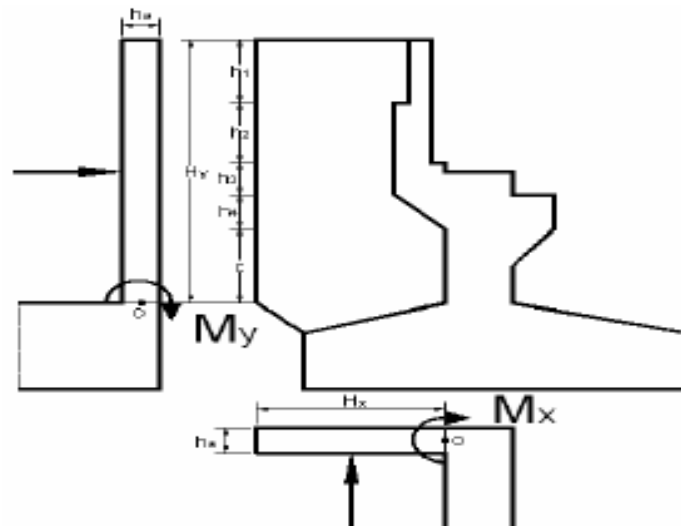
Potongan A-A (Penulangan *Abutment*)
